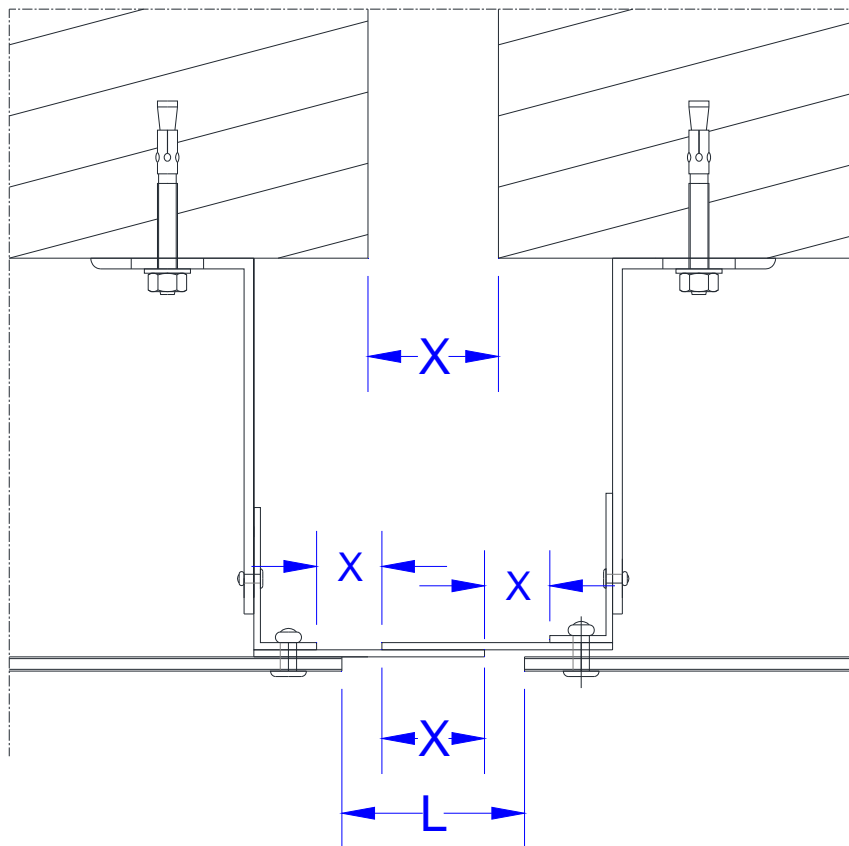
Arrêt latéral sur mur béton – Coupe horizontale
